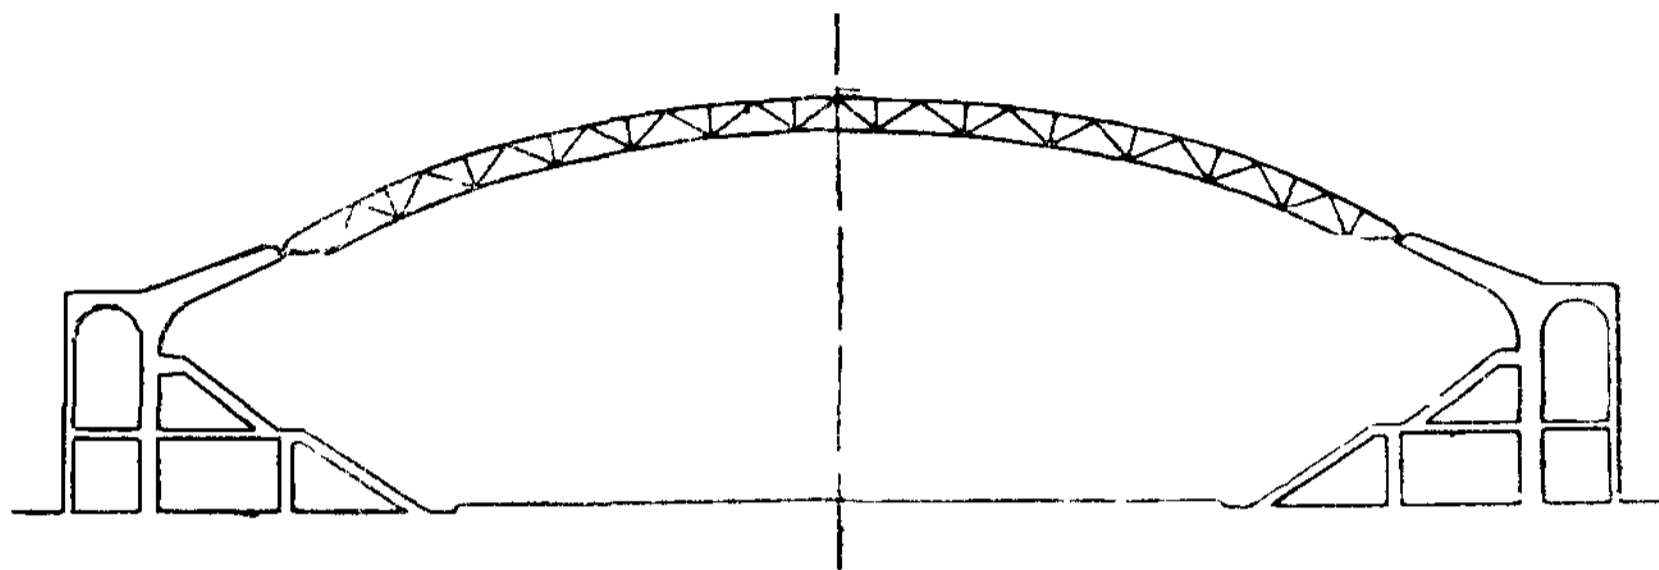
Арочное перекрытие с опиранием арки на железобетонные
